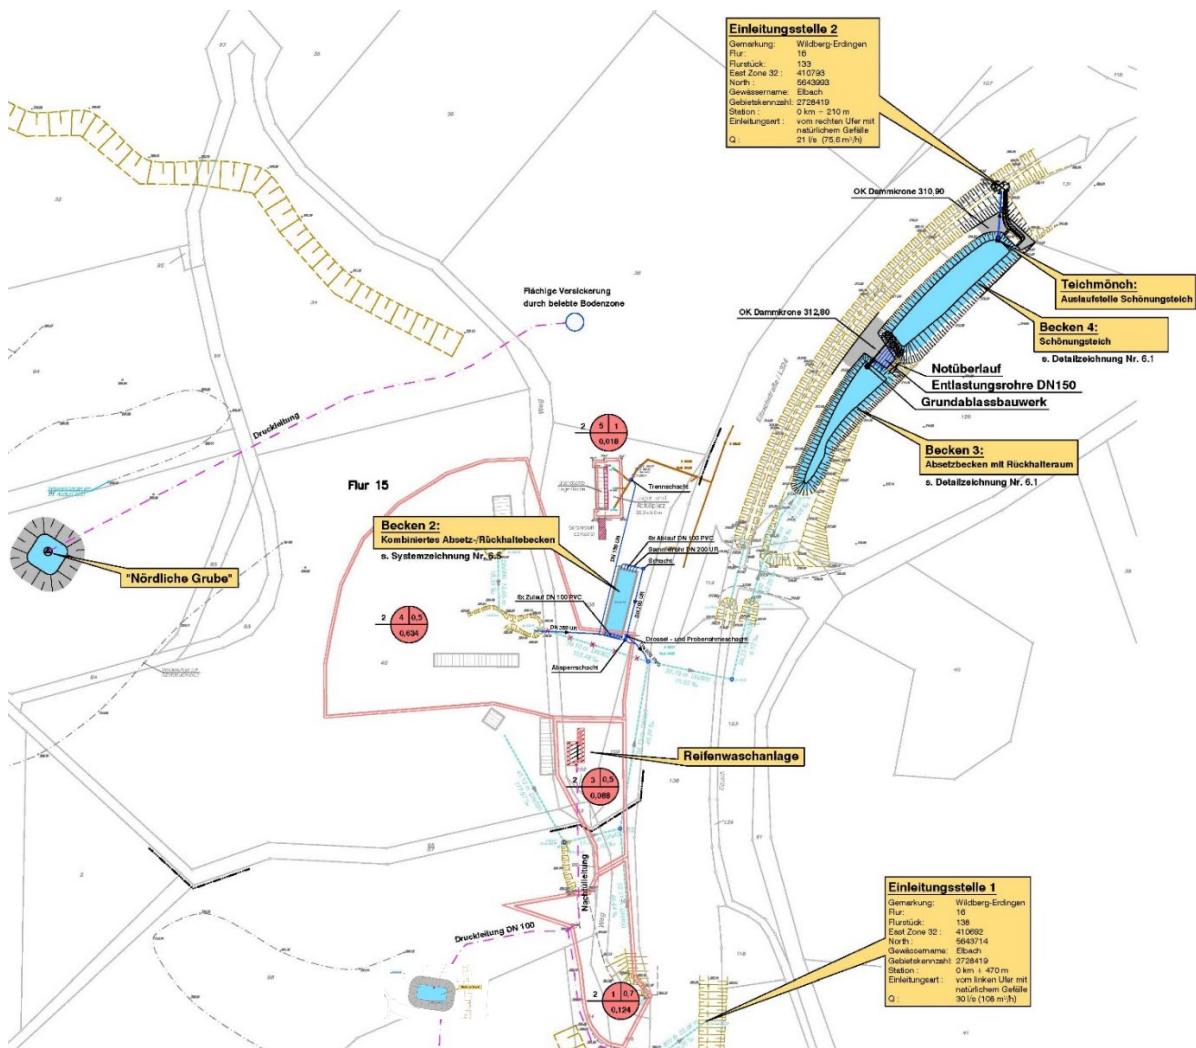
Auszug aus einem aktuellen Entwässerungstechnischen Lageplan für den Steinbruch Jaeger (aus Klapp & Müller GmbH, Stand: 11.07.2022).
